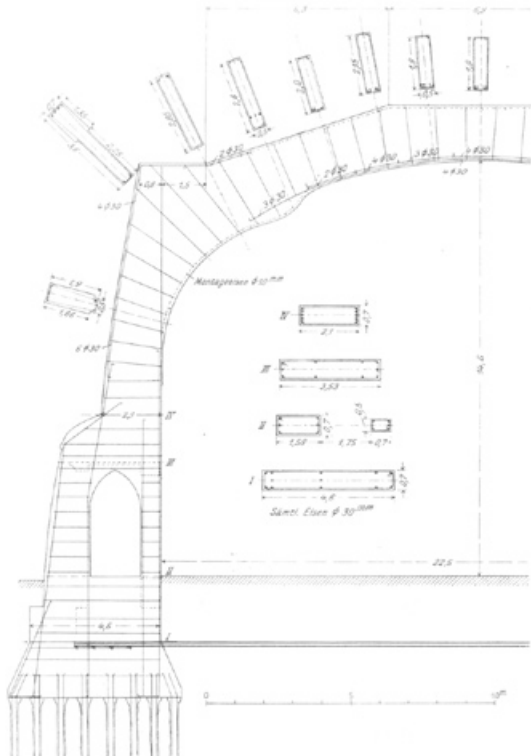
Bewehrungsplan eines Bogenbinders (DBZ 1910, S. 223).
